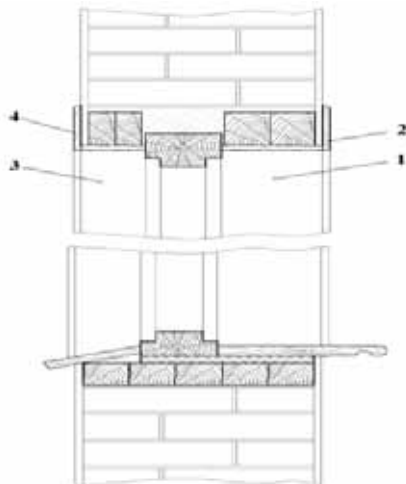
Устройство несущей перемычки над оконным (дверным) проемом (при расположении балки перекрытия над проемом):
